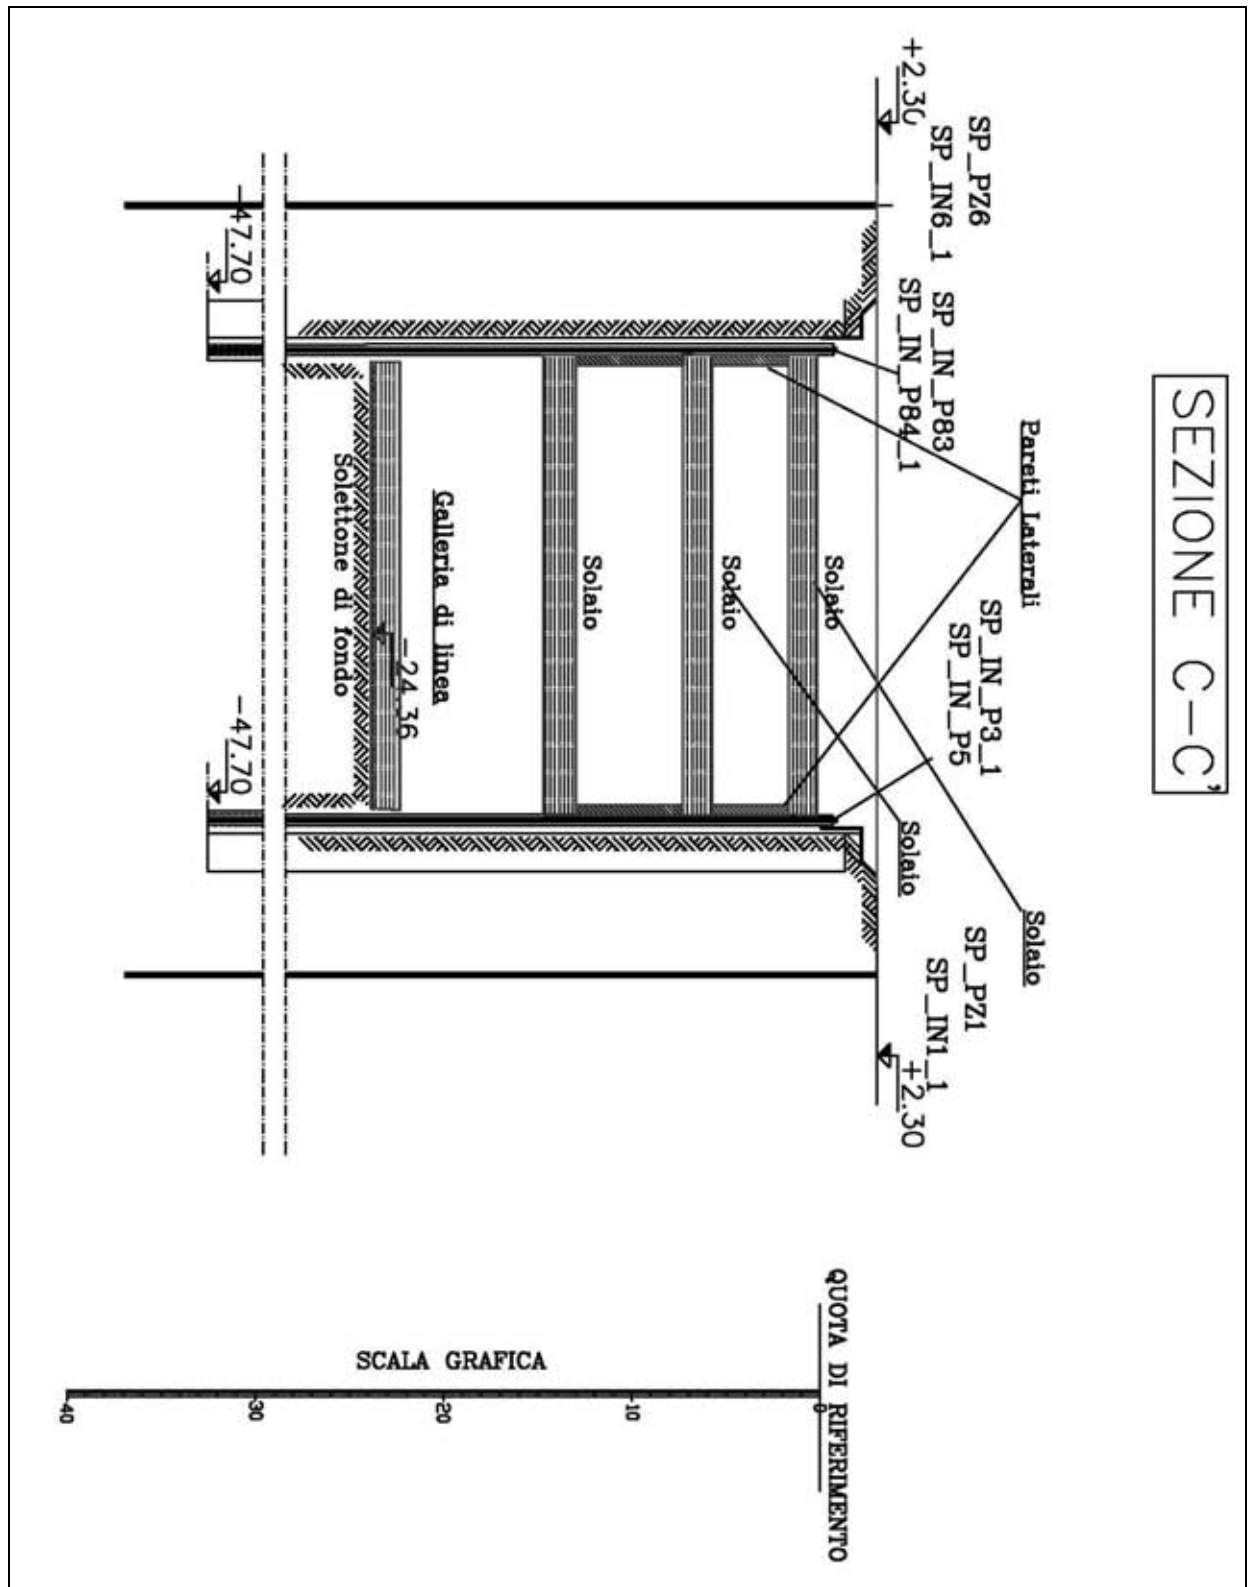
Sezione C-C' pozzo stazione, raffigurante la suddivisione in aree di lavoro.
